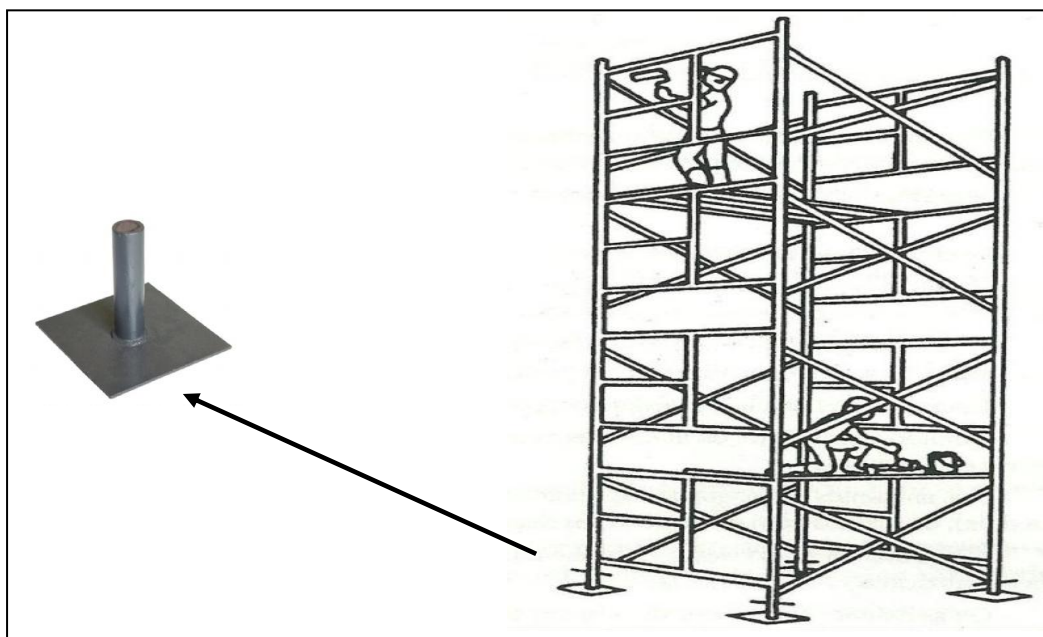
Exemplo de andaime simplesmente apoiado fixo
